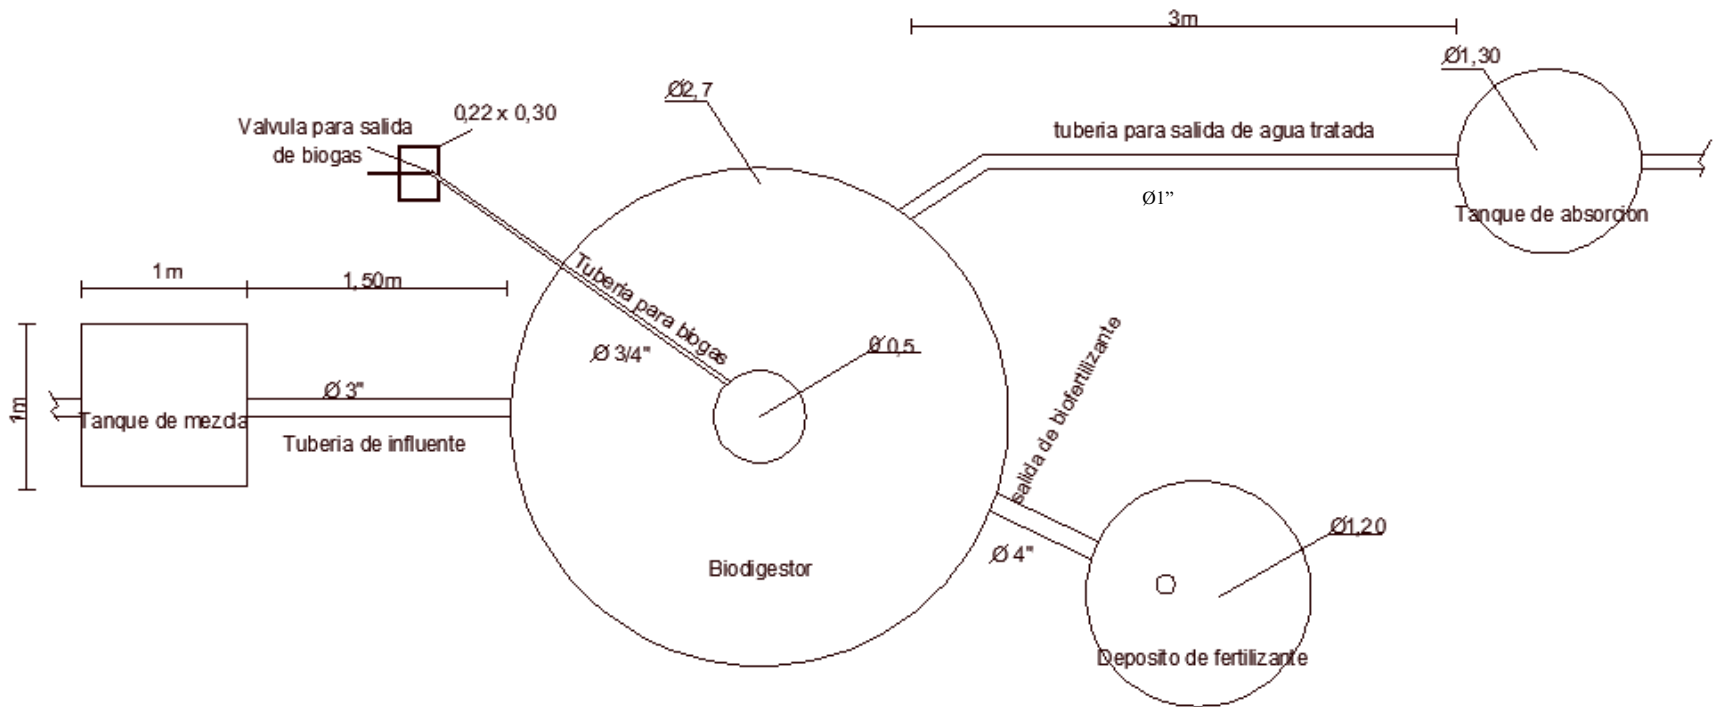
Perfil en planta de los componentes del biodigestor con medidas y diámetros de tuberías
